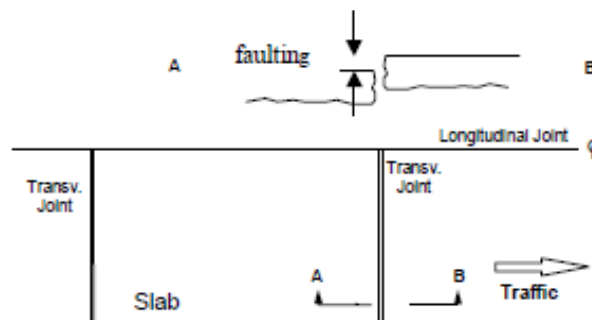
Esquema de Escalonamiento de losas para pavimentos de concreto hidráulico JPCP.
